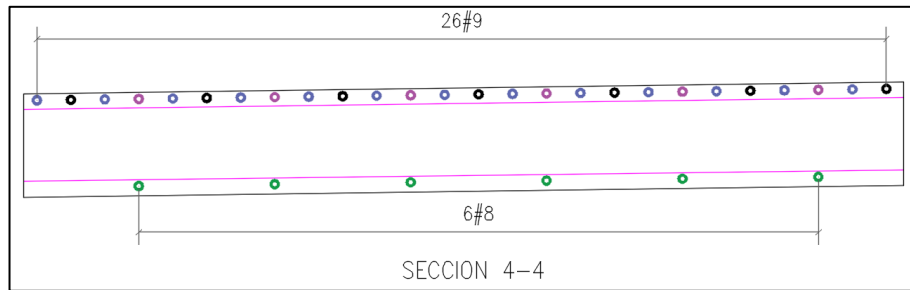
Refuerzo suministrado corte 4-4 – FIN
